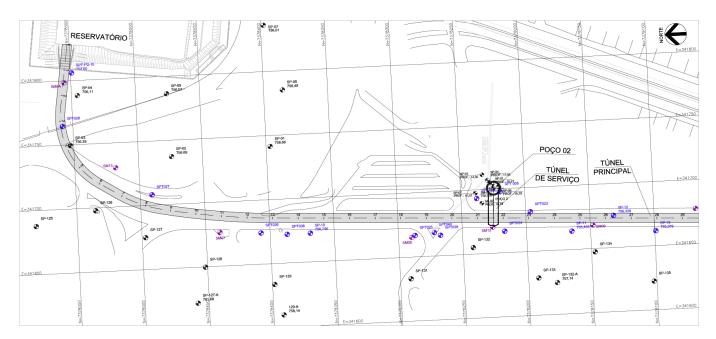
Planta geral de localização do túnel – parte 2. (Fonte: Projeto Executivo GeoCompany)
